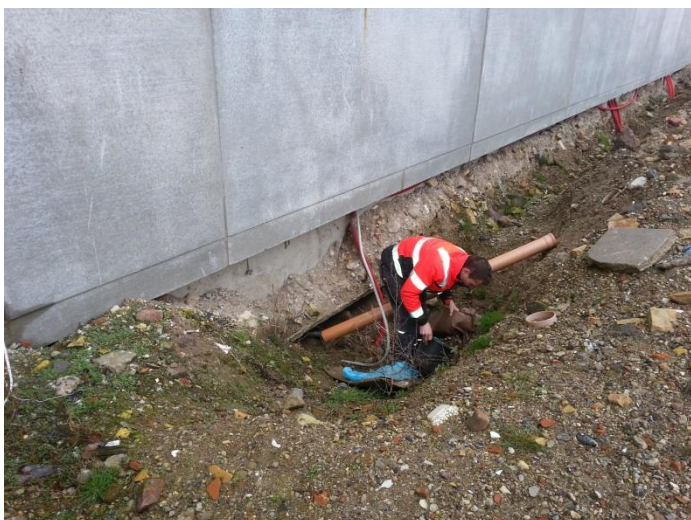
Fyldet under dele af Wittrup Seafood bygningen har sat sig til under betondæk.
